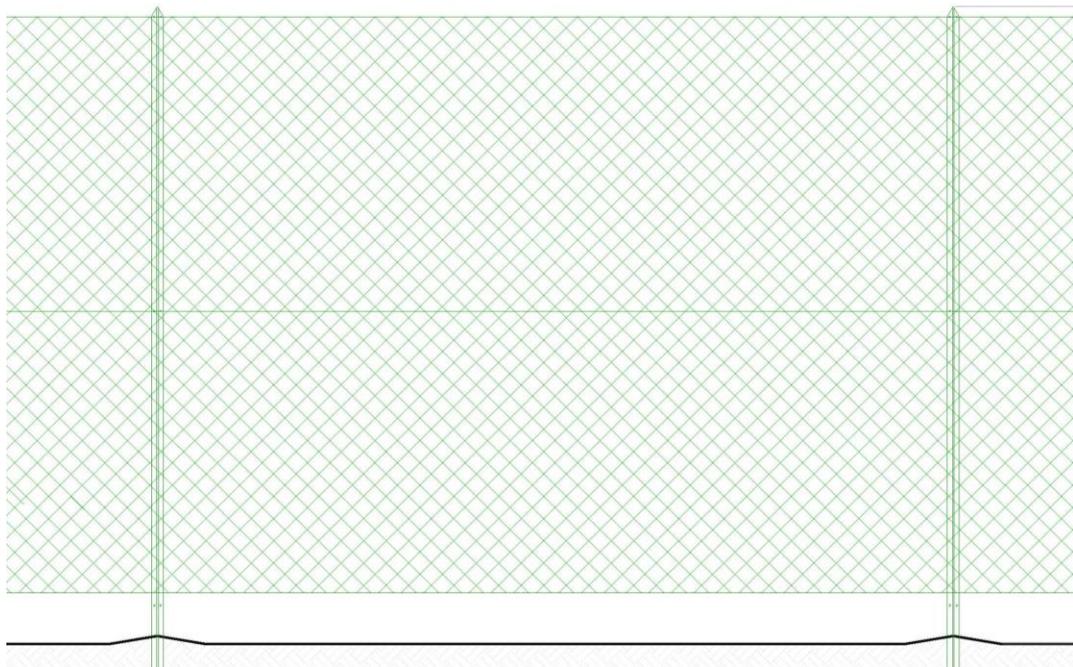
Particolare recinzione perimetrale con apertura inferiore (20-30 cm).
